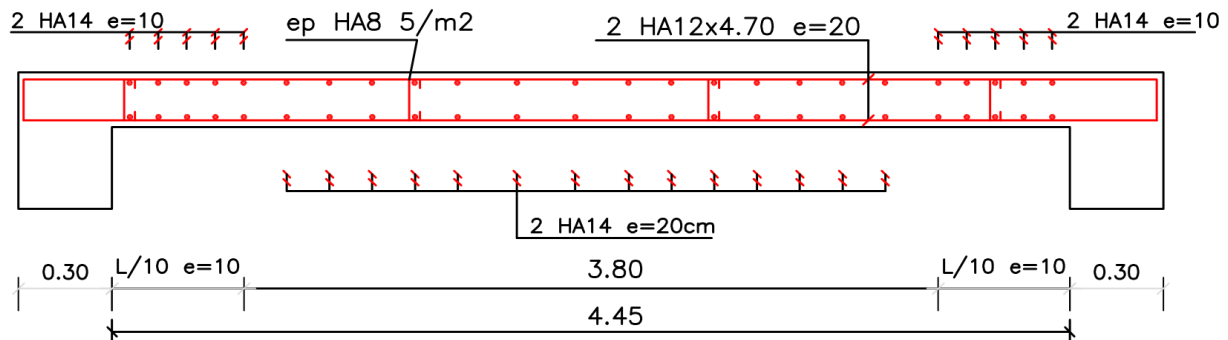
Coupe horizontale de Ferrailage des voiles longitudinal au niveau RDC
